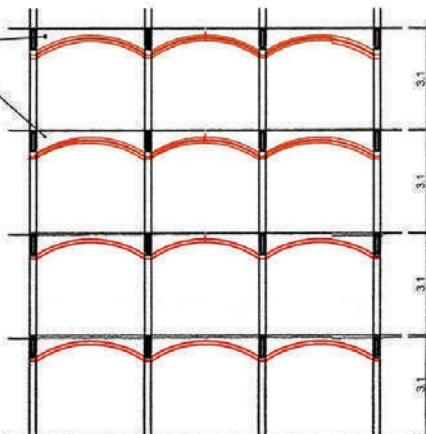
Corte transversal da estrutura com abóbodas. Vemos as vigas transversais por cima das abóbodas, sua parte menor é no meio do vão. (*-5).
